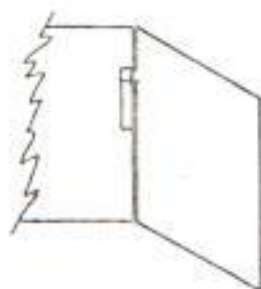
DETALLE DE PUERTA (TRASLAPE)
